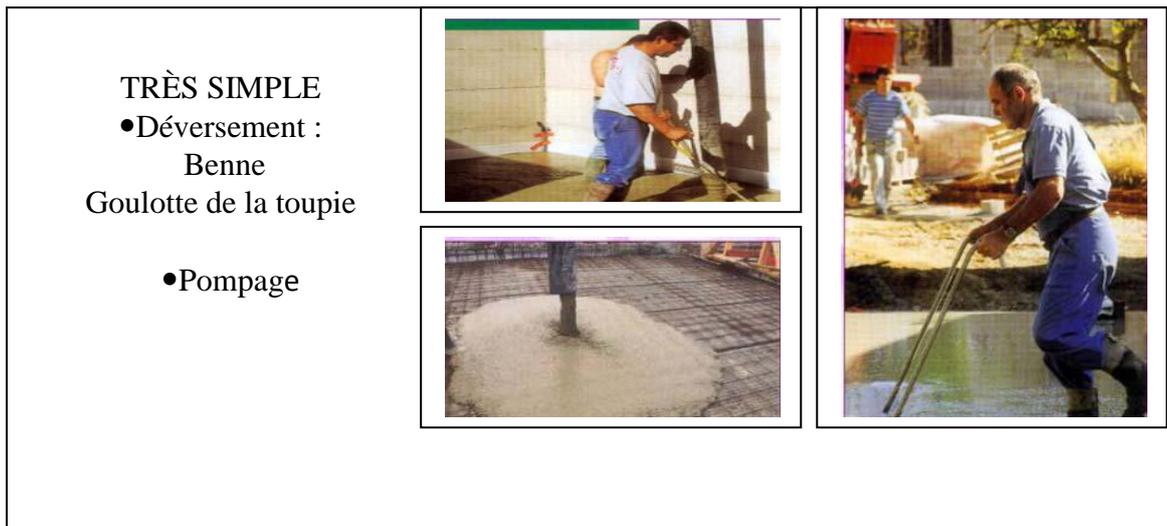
; Application horizontale de béton autoplaçant (beton autonivelantes)
